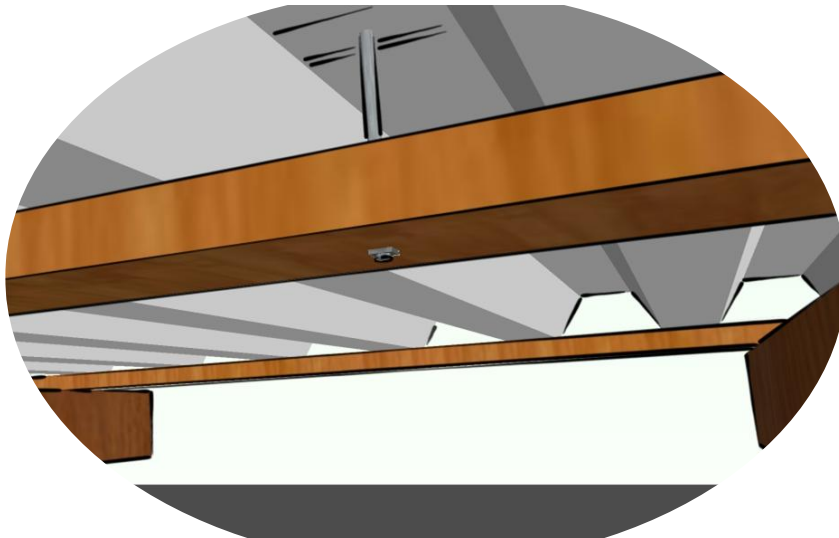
Detalhe do travamento do arranjo dos módulos na estrutura do detalhado
